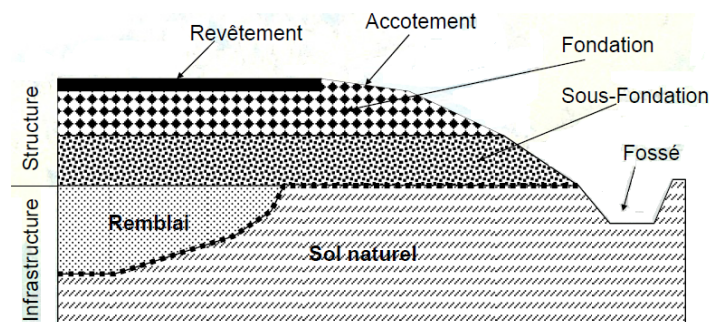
Coupe type d'une chaussée (Doré & Zubeck, 2009)
